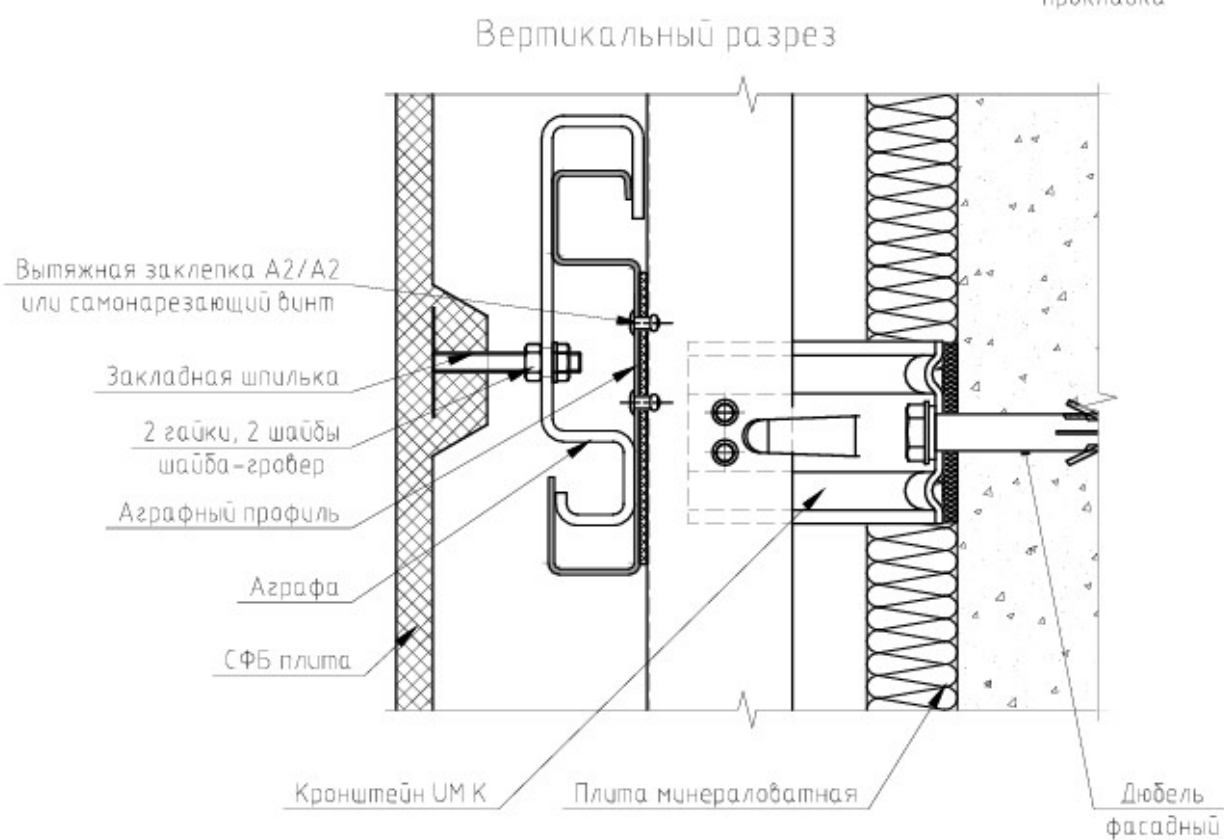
Крепление облицовки с помощью закладных деталей с резьбовой шпилькой к аграфному профилю НФС
